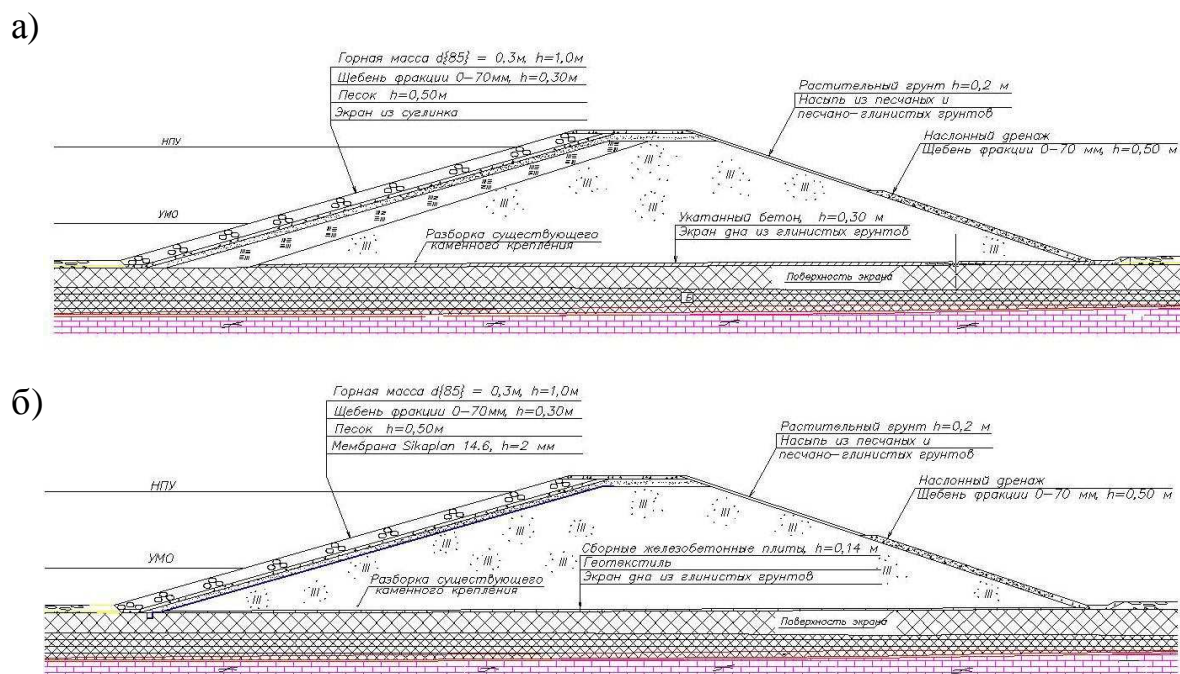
Временная дамба: а) вариант 1; б) вариант 2
